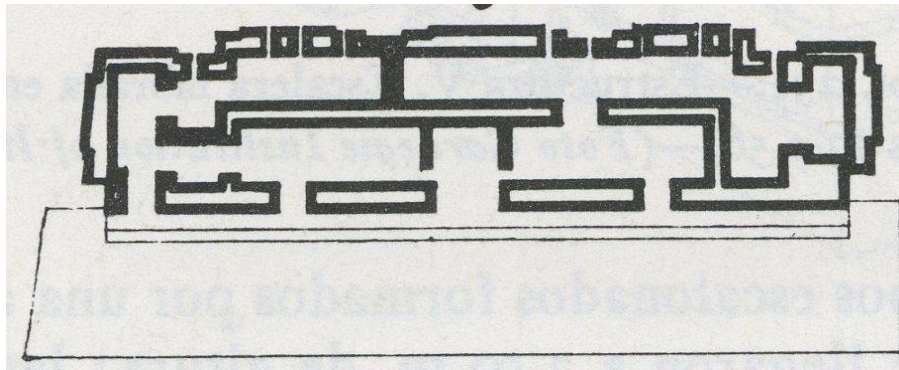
, Planta de Crestería Edificio A-18. Planta de la crestería del Edificio A-18 de Uaxactún. Tomado de Marquina y modificado por Miguel Acosta 2011.
